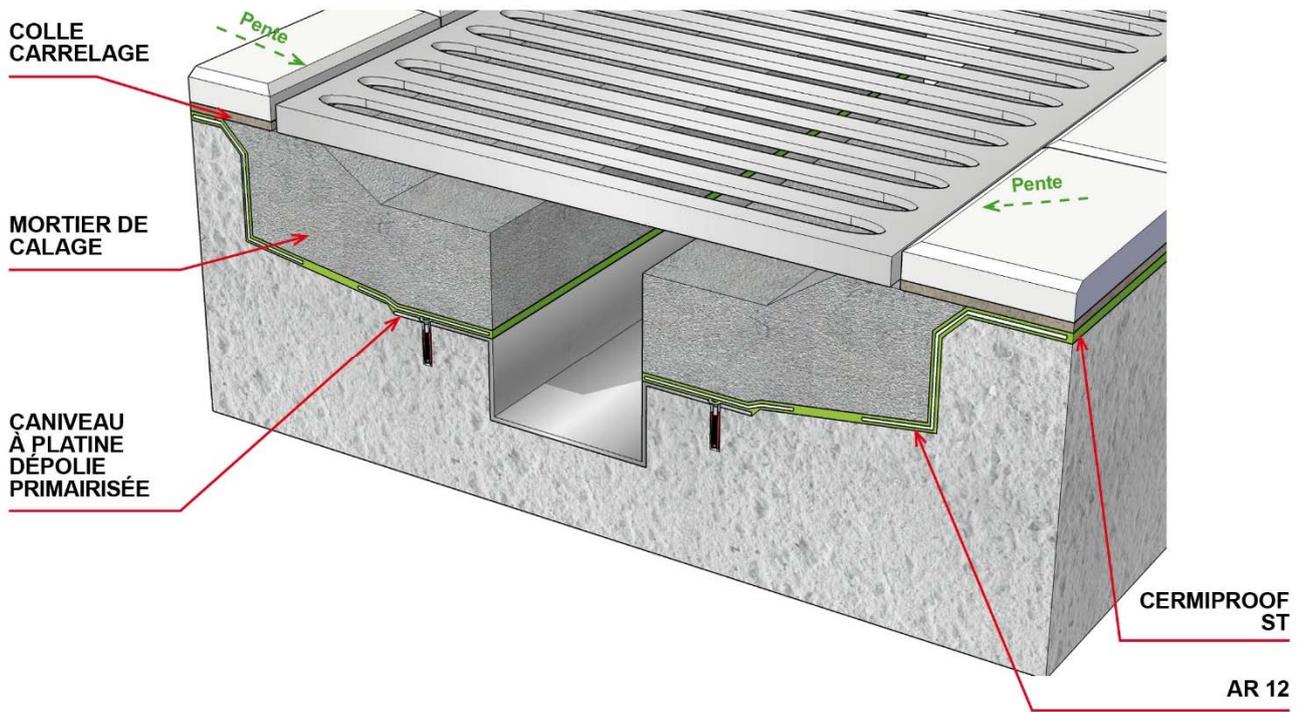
Raccordement à un dispositif d'évacuation des eaux : Caniveau en pose collée
